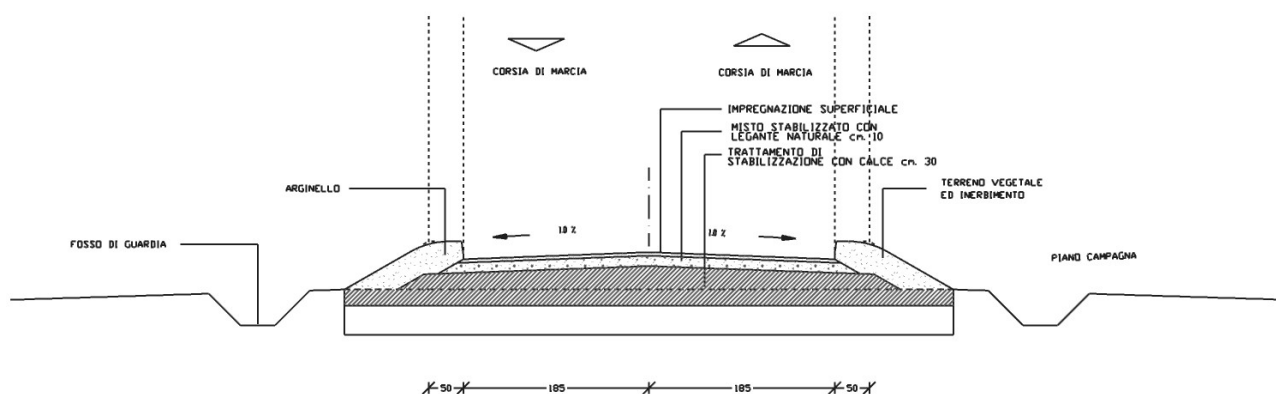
Sezione tipo piste di cantiere che rimarranno in essere
